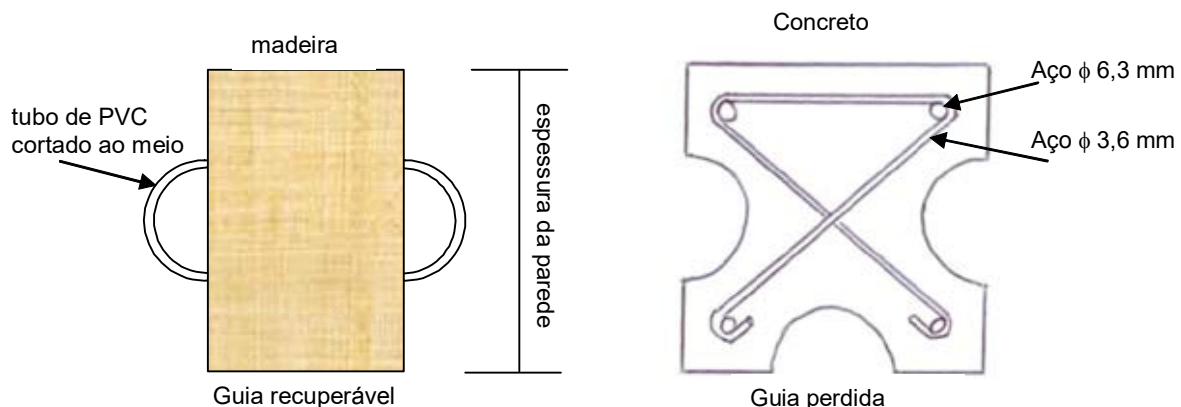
Detalhes das seções das guias de madeira e de concreto
